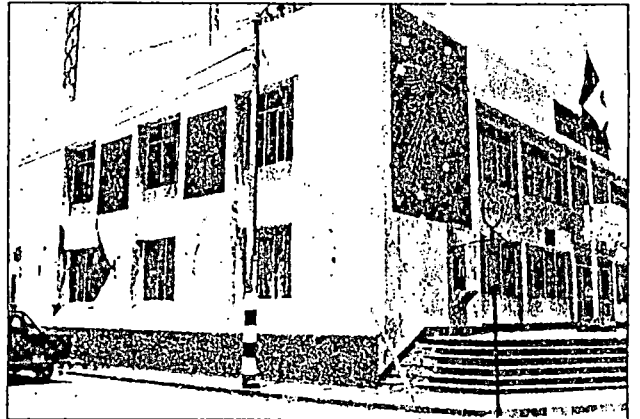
Edificio de la Municipalidad de Nasca. Estructura de concreto armado. La tabiquería de relleno presenta grandes daños, pero no hay daños estructurales.
